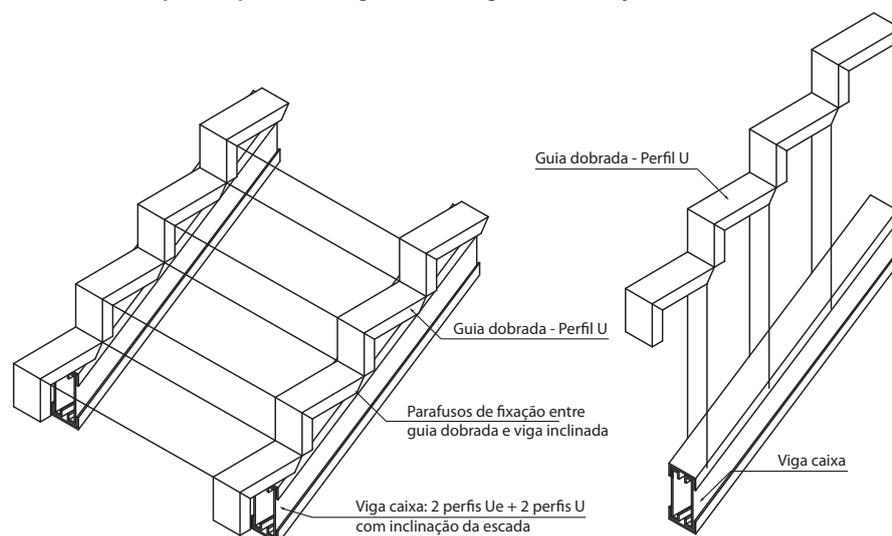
Desenho esquemático de escada viga caixa inclinada
